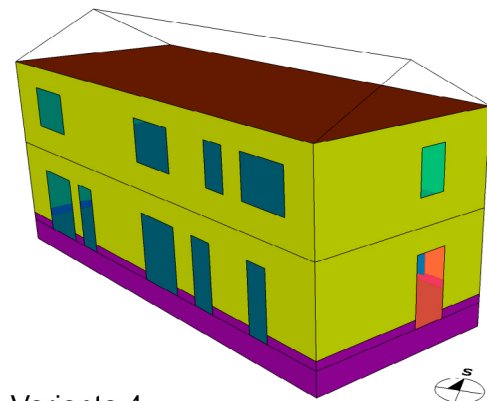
Varianta 1 Pórobetonové tvárnice 250 mm + EPS 260 mm.
